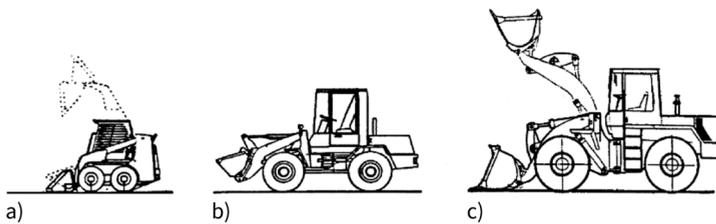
Beispiele für a) einen Kompaktlader, b) einen Kleinlader auf Rädern und c) einen Großlader auf Rädern (adaptiert nach [34])
